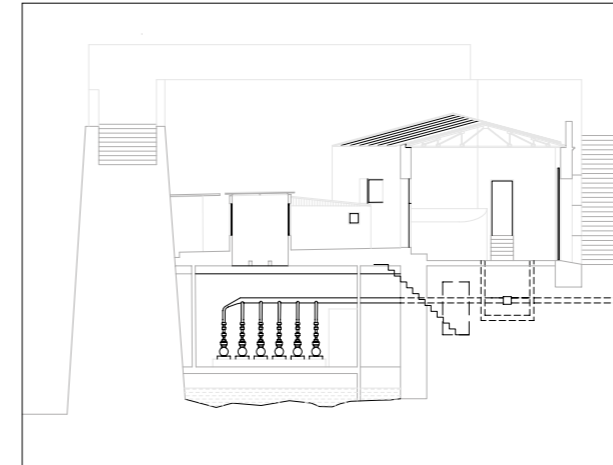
Sección por la muralla de la Fuente, patio y edificio industrial, y planta general de su estado en 1996. (MJB 1999).
